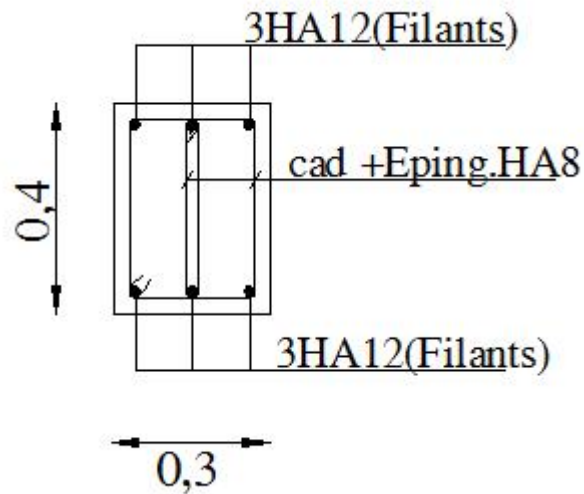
Coupe horizontale A-A de la poutre de chaînage.
